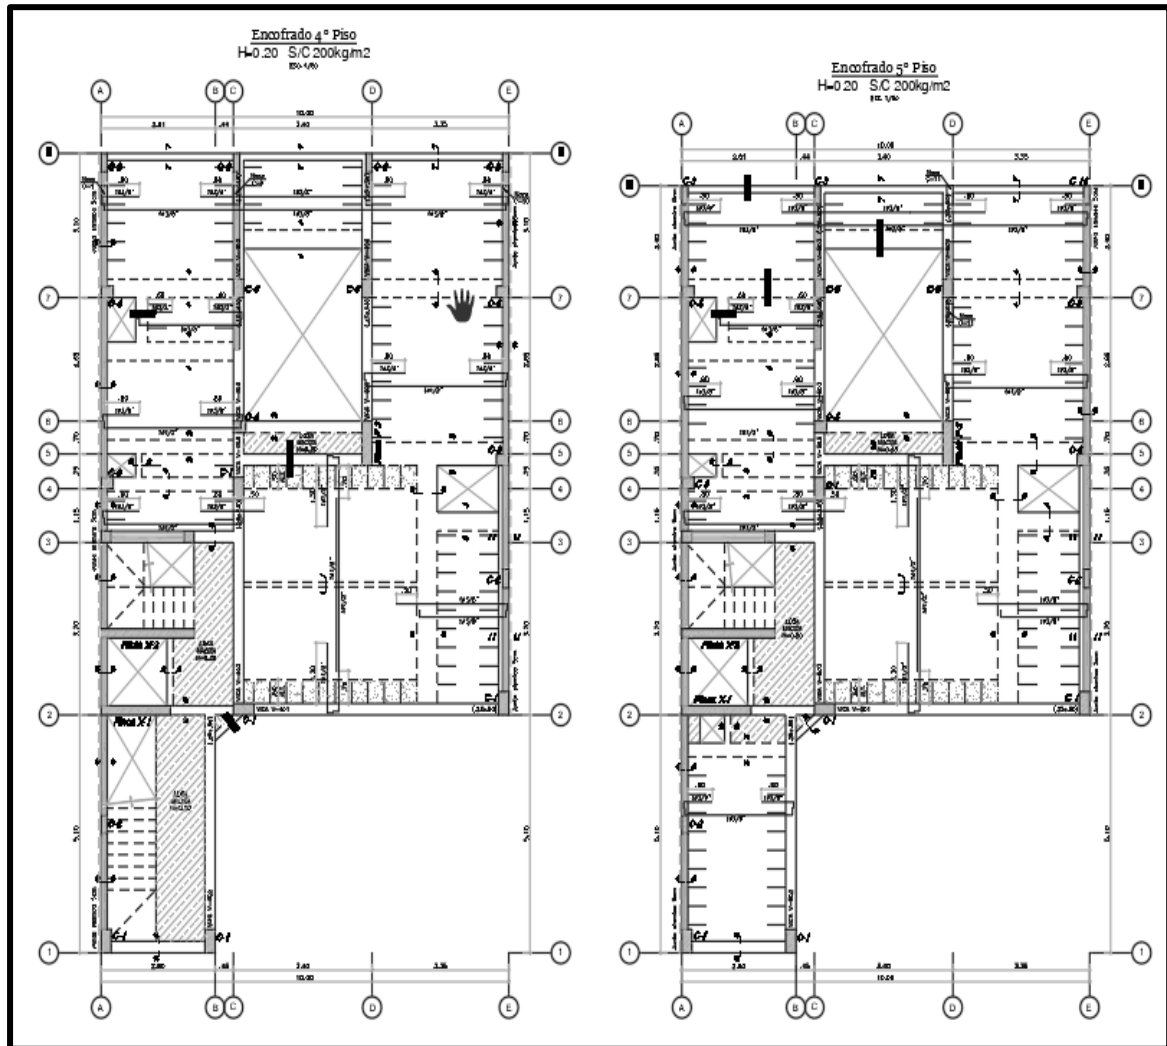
Encofrado 4° y 5° piso (ampliación) suben los mismos elementos estructurales que vienen del 1°, 2° y 3° piso.
